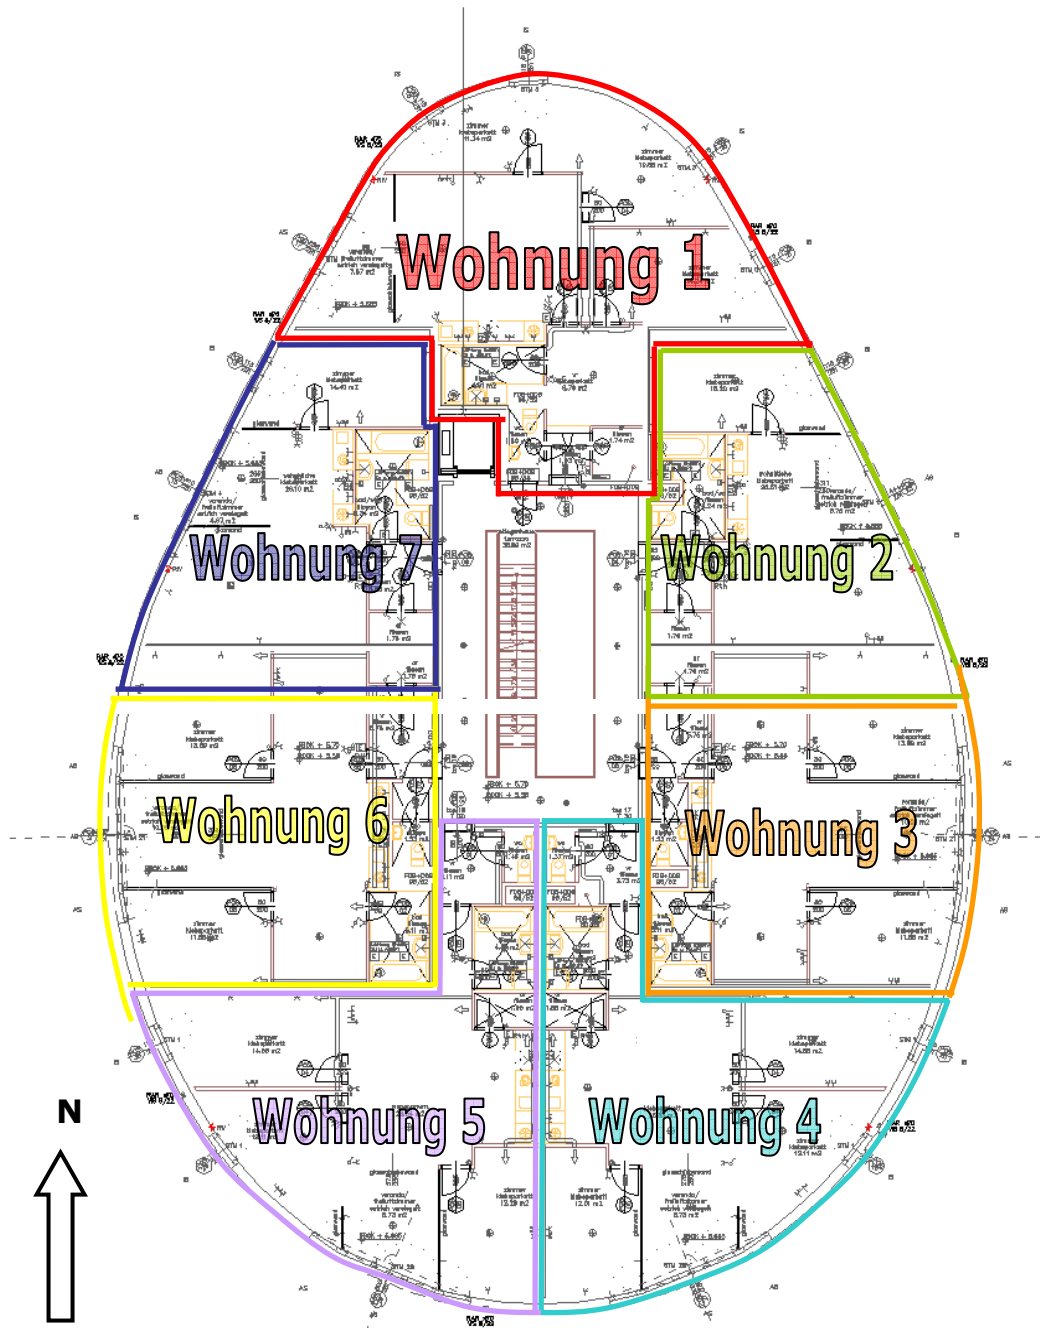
Grundriss PH Melone 2. Obergeschoß [Lautner G.]
